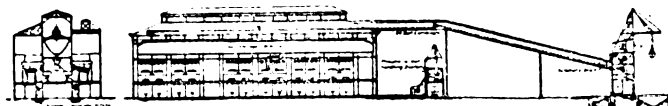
Centrale della Havana Electric Railway, Light and Power Co.
